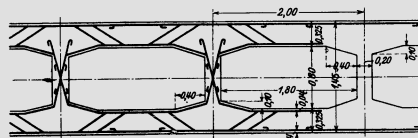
Eisenbetonhohlkern (Entwurf). Maßstab 1 : 100.
